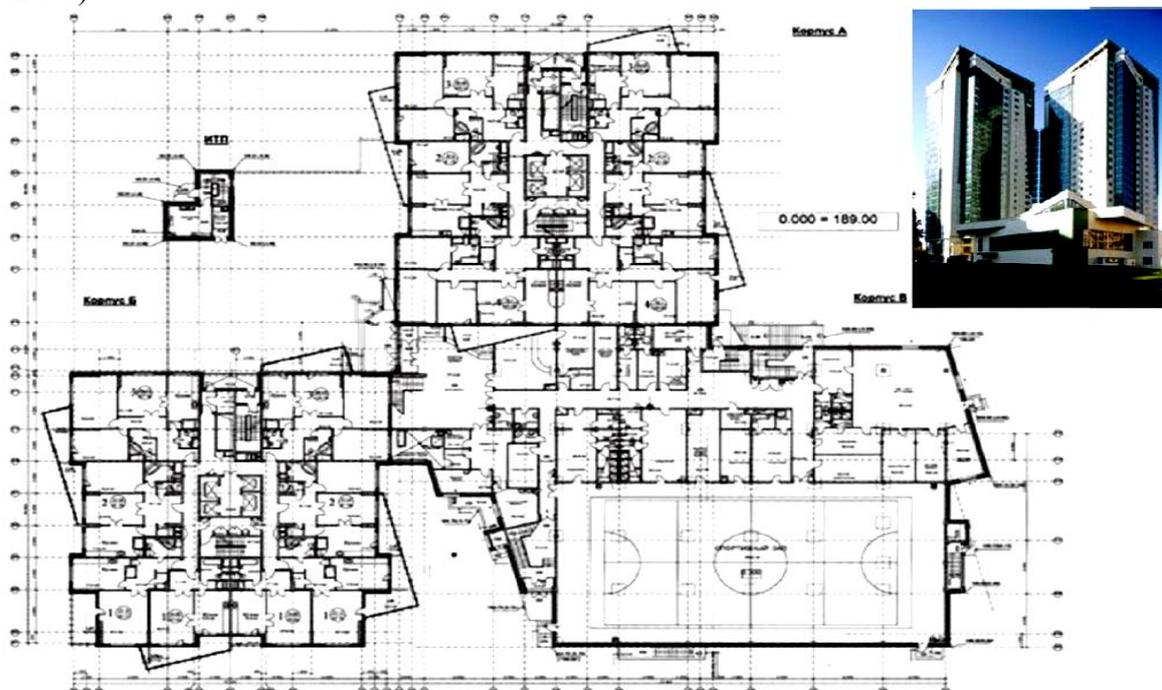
План 25-этажного жилого дома с монолитным каркасом и колоннами прямоугольного сечения
